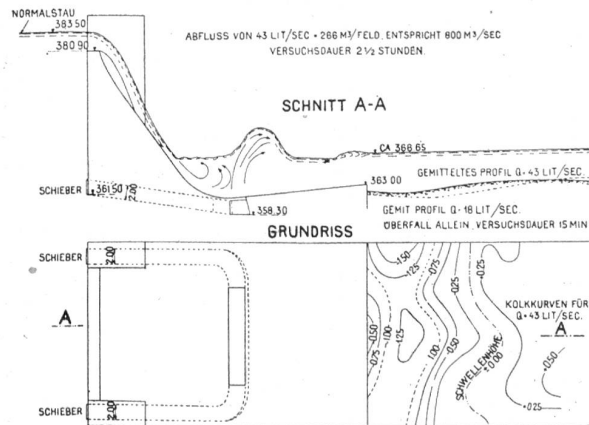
Grundriß und Längsschnitt durch das Versuchswehr. Maßstab 1 : 1000.
